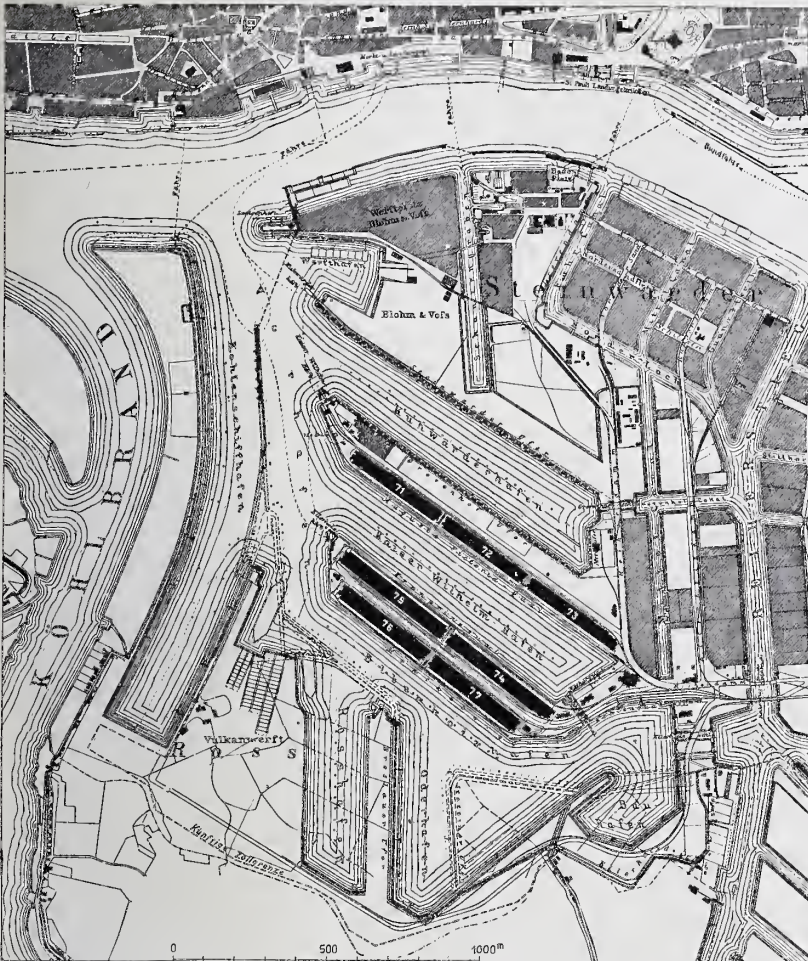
Lageplan der neuen Hafenanlagen auf Roß-Elterholz.
